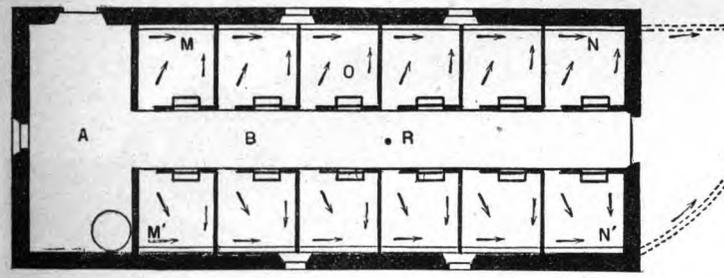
Plan d'une petite porcherie d'engraissement.
